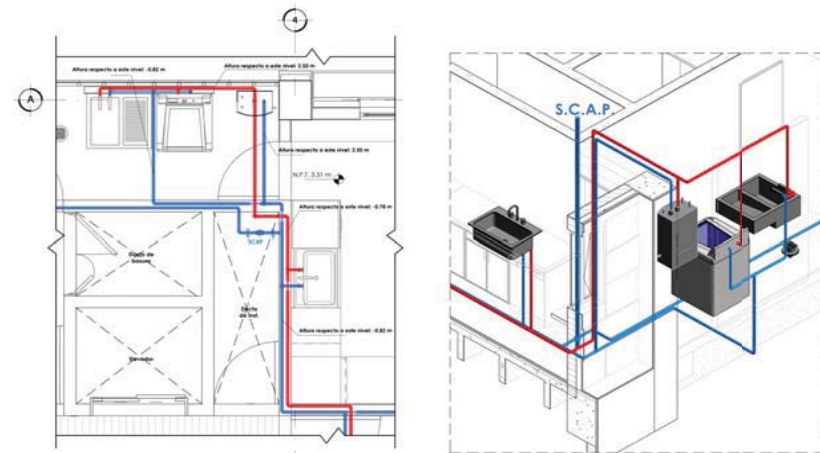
Detalle del criterio de alimentación para el área de servicios de I departamento tipo.
